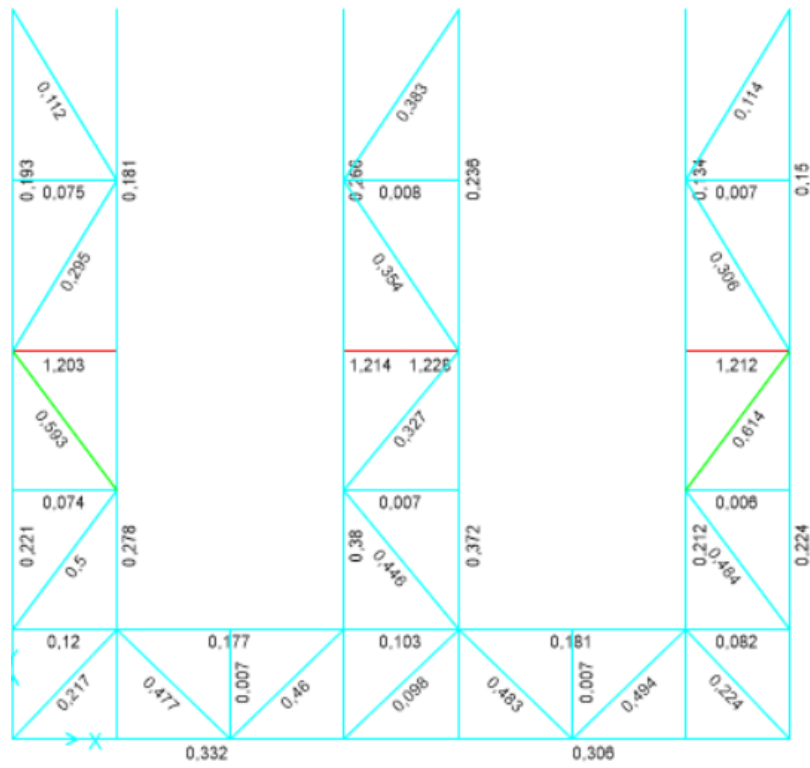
Factores de utilización vista en planta elevación 13 m.
